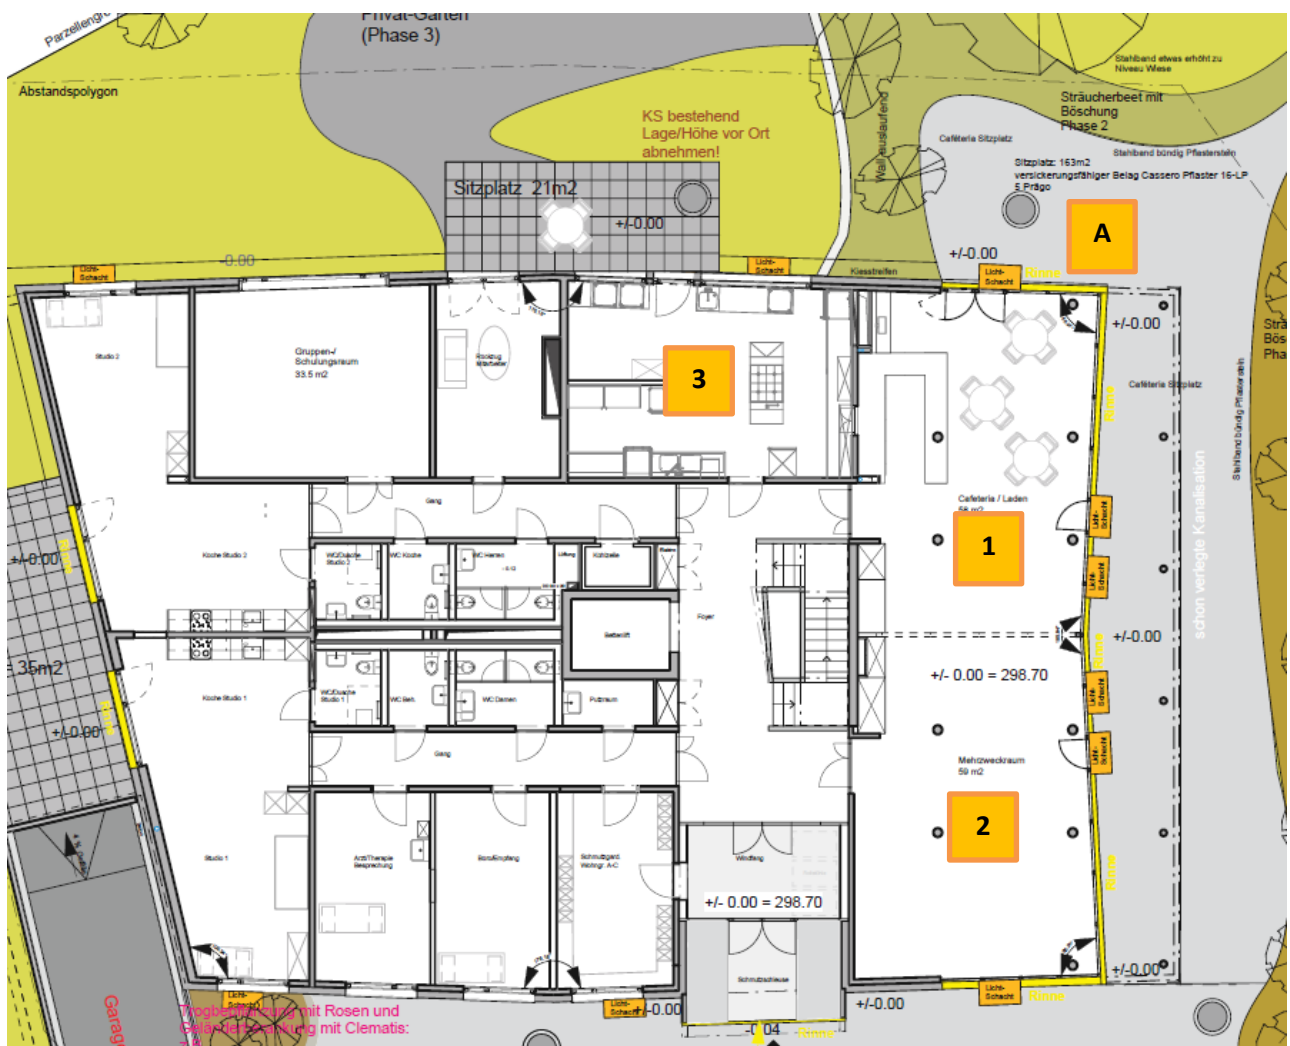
Grundrissplan Erdgeschoss der Wohnstätte
